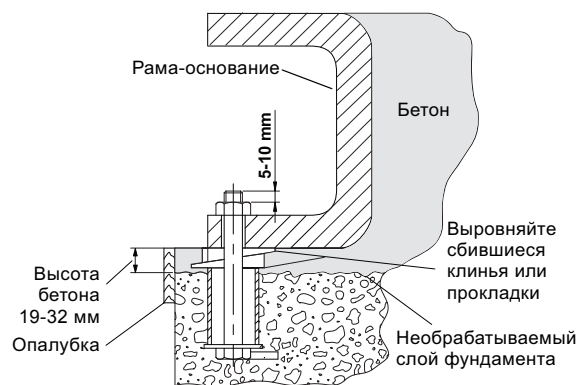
Вид в разрезе фундамента с фундаментным болтом, бетонной заливкой и рамой-основанием
